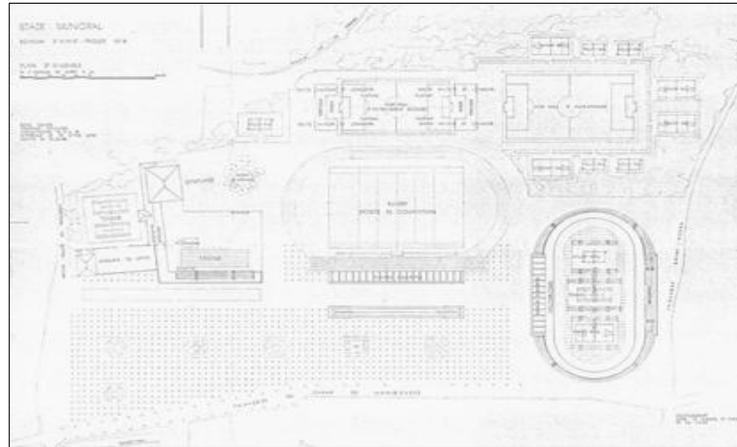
Plan de masse du stade municipal à Aix en Provence, F.Pouillon architecte, 1946- 1947. [6]
